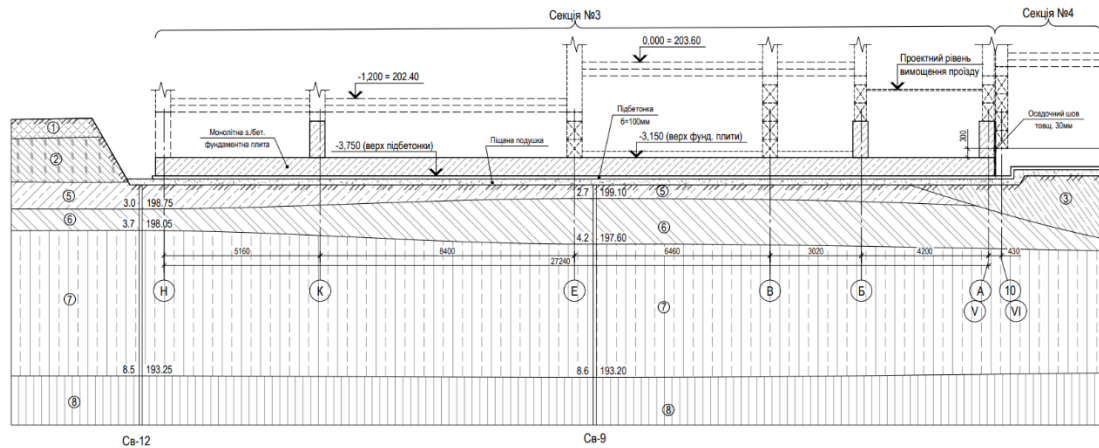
Схема посадки фундаментів на ґрунти
